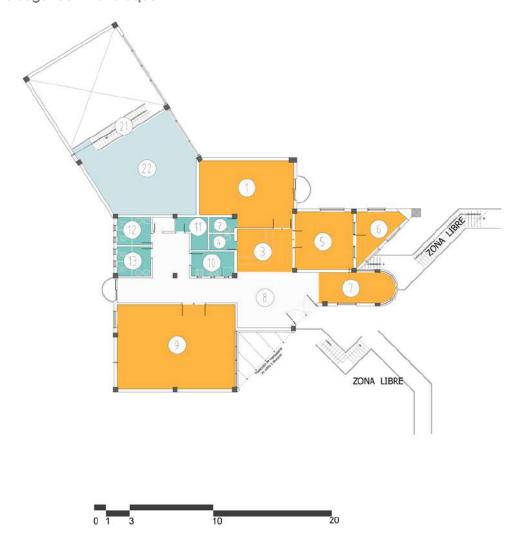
Planta 2 Bloque 44. Fuente: Equipo de diagnóstico.
